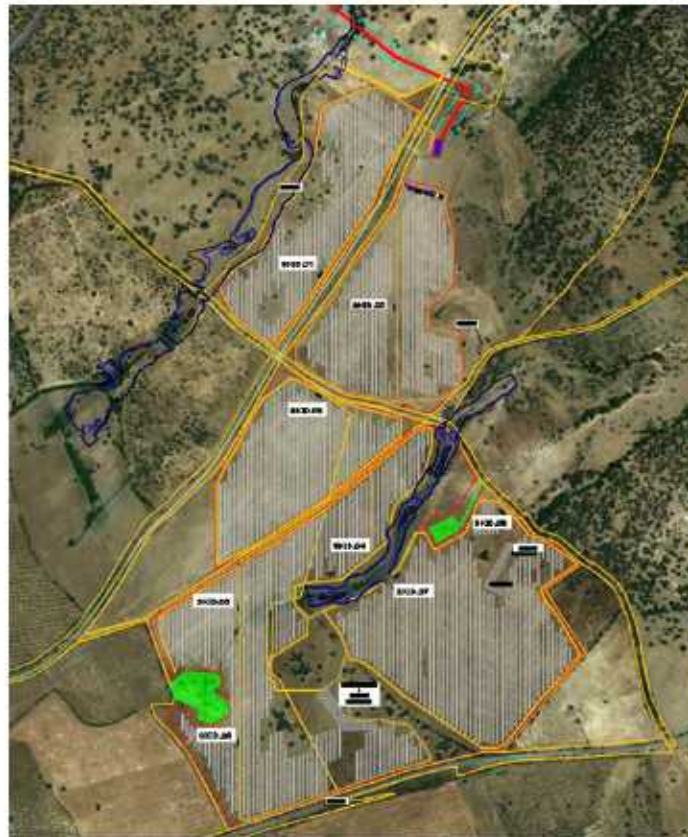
Layout PV Beturia. Fuente: Ingenostrum.
